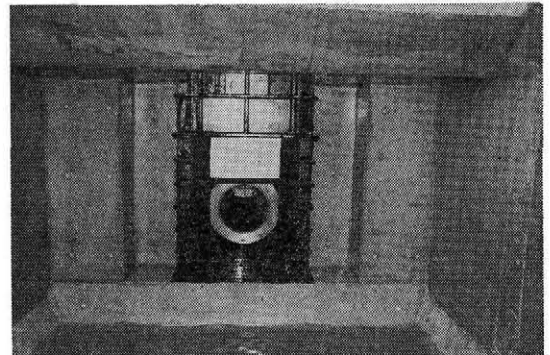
減勢室よりジェットフローゲート（φ400）を望む
